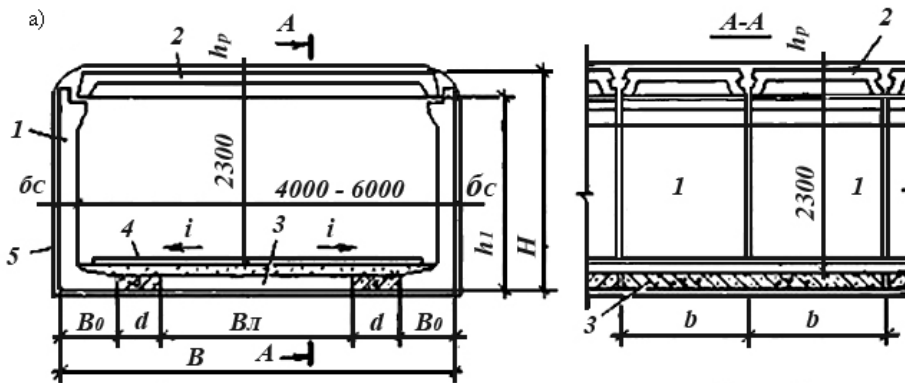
Конструкція однопролітного пішохідного тунелю: 1 – стіновий блок; 2 – блок перекриття; 3 – лотковий блок; 4 – покриття підлоги; 5 – гідроізоляція
